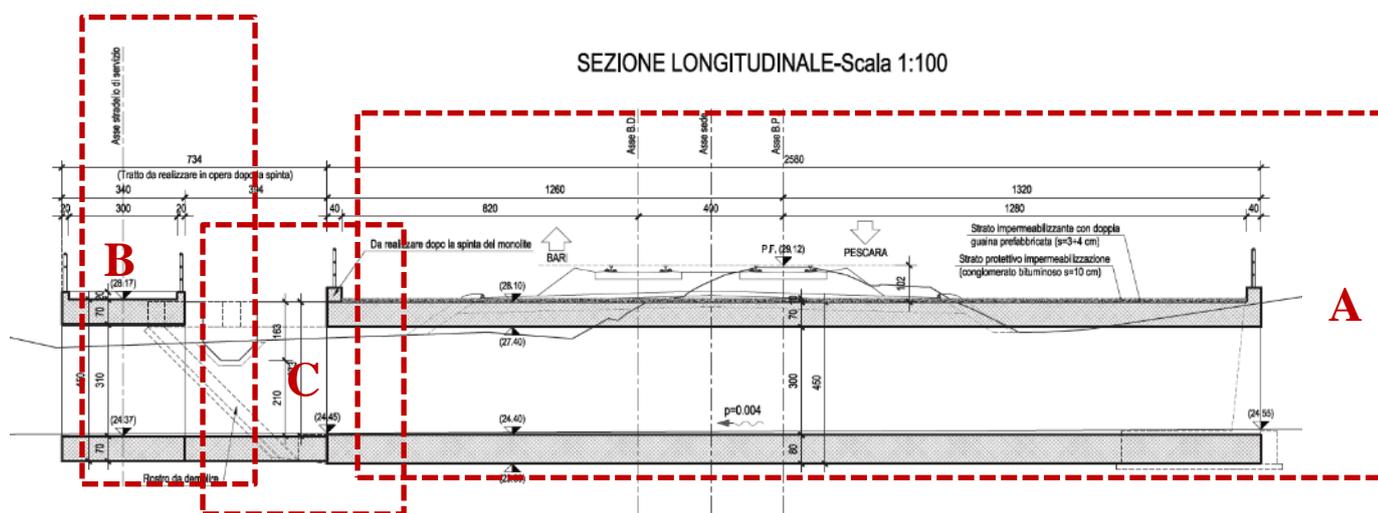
Adeguamento idraulico Fosso Pontonicchio - Sezione Longitudinale sul sovrappasso stradale, sul monolite e sul manufatto di raccordo
